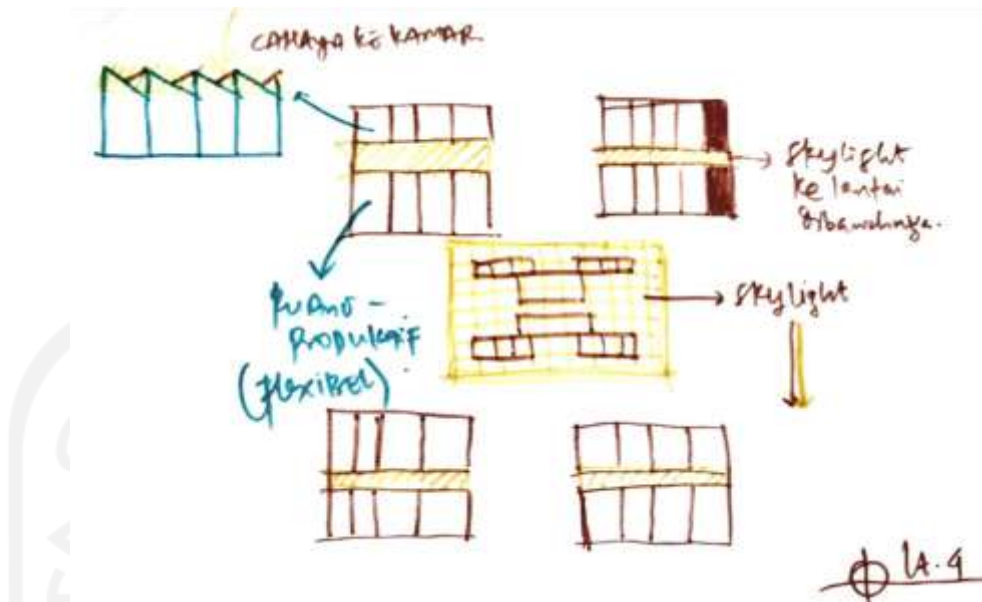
22 Zoning dan Konsep Ruang Lantai 2
